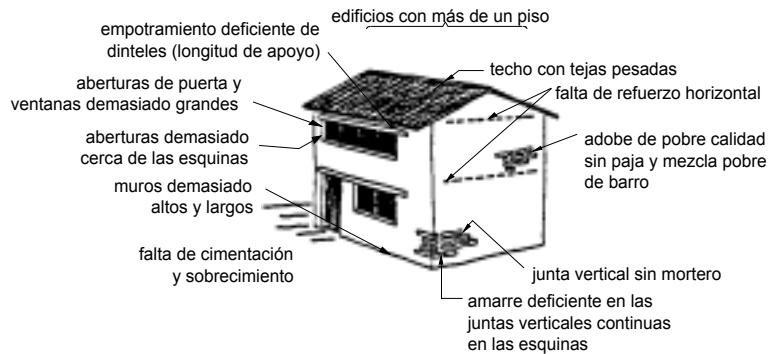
Tipos de falla en estructuras de mampostería de adobe
